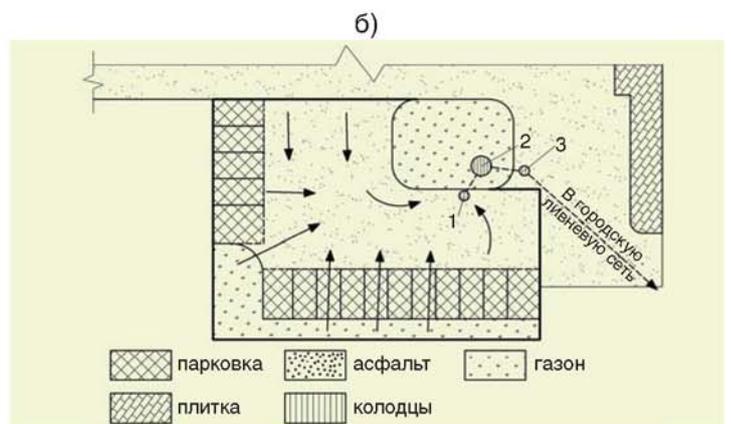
Размещение двухкаскадной установки глубокой очистки поверхностного стока на территории автопарковки
